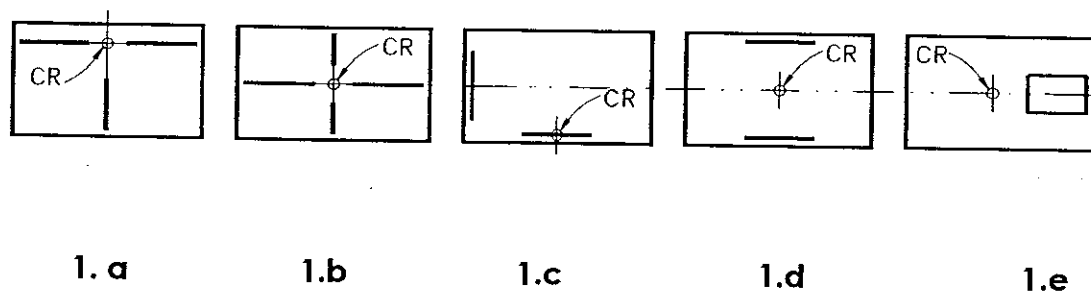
ARREGLOS DE MUROS EN PLANTA
